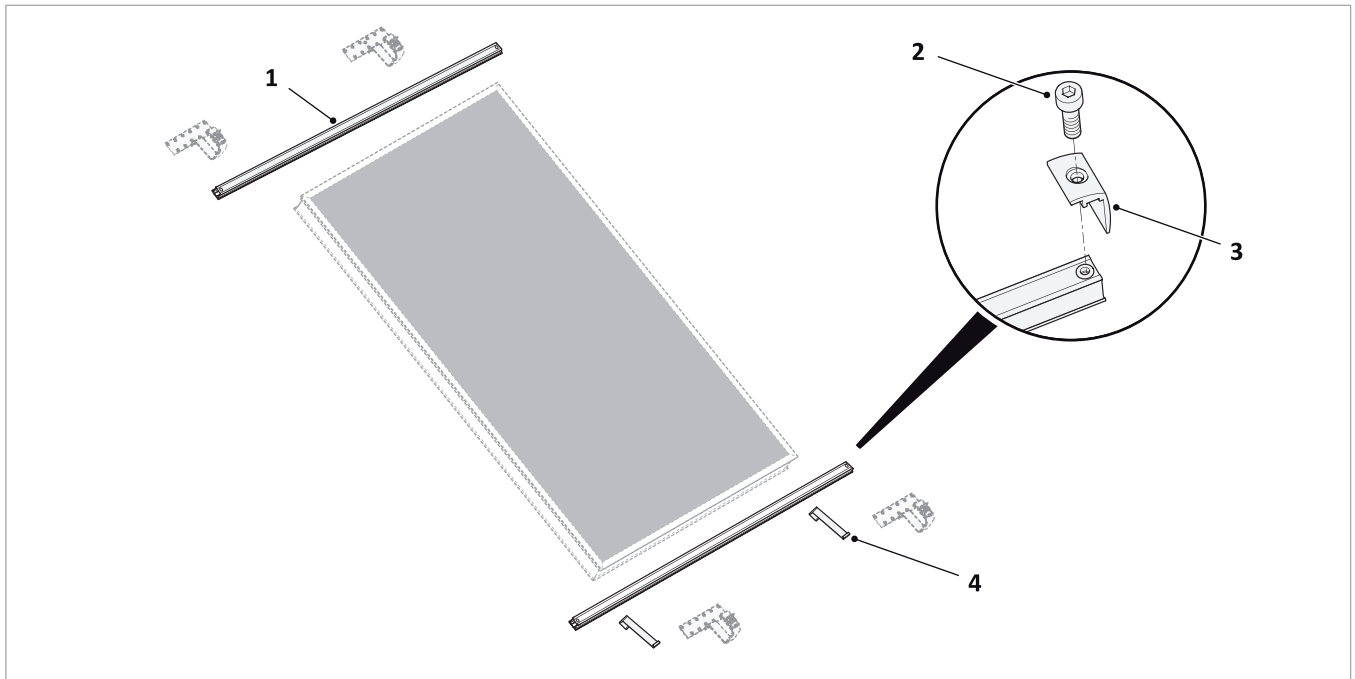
kit de rails de surimposition (capteur et fixation sur toiture non incluse dans la livraison)
